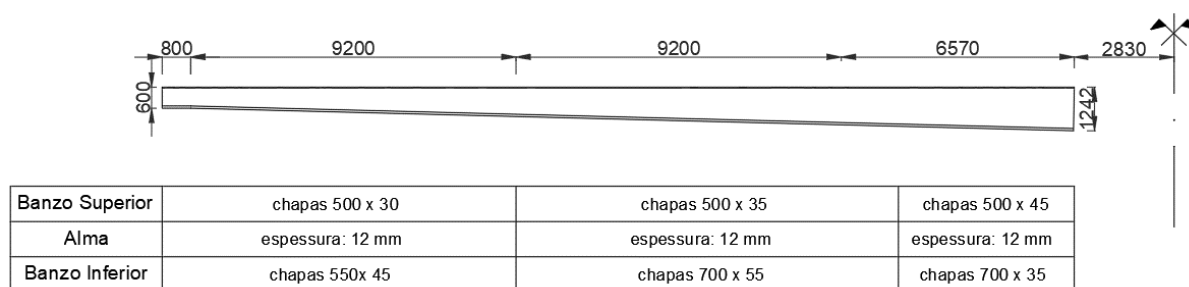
Geometria das vigas metálicas principais (dimensões em milímetros)
